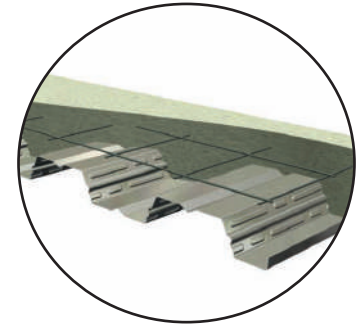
Detalle entresijos de metal-deck. Fuente: Metaldeck
